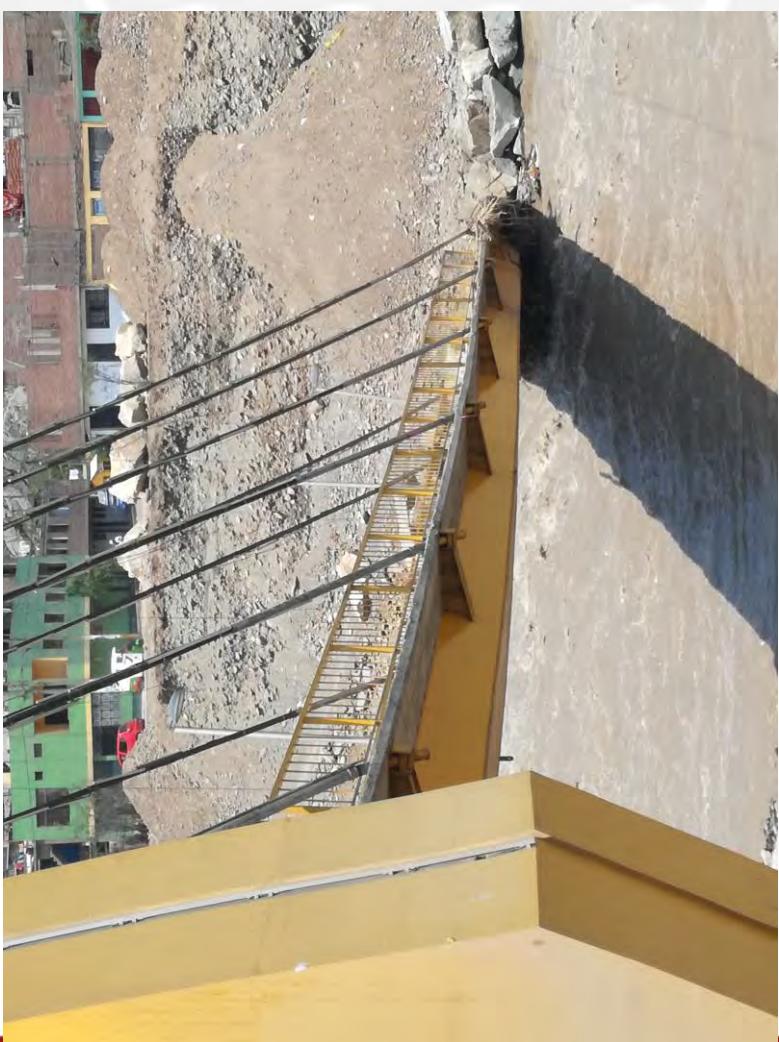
Vista del suelo malo donde fue cimentado el estribo izquierdo
